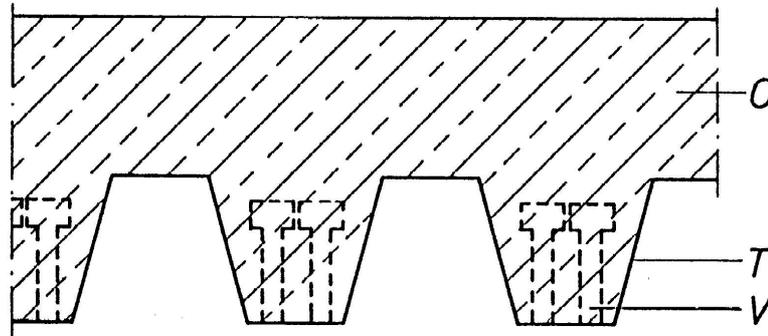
Stahlbetonrippendecke, mit Aufbeton, statisch nicht mitwirkende Zwischenbauteile
